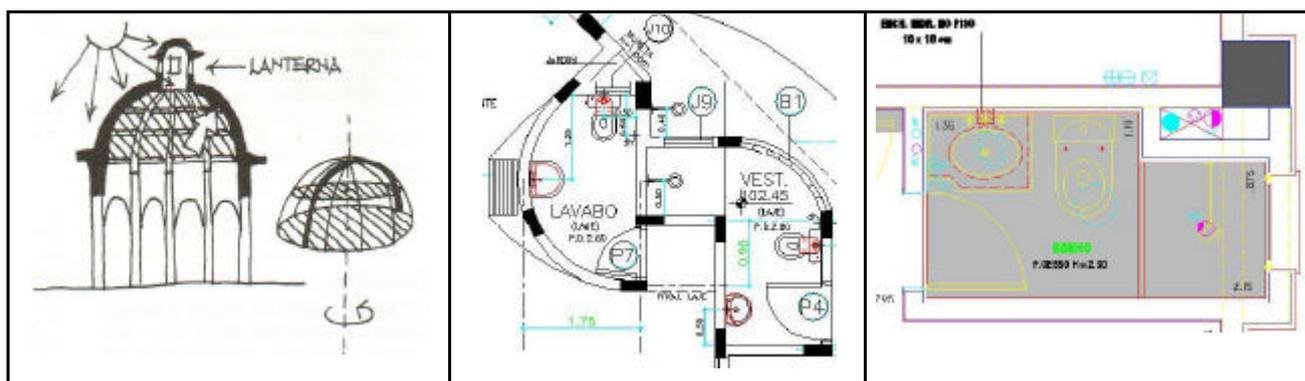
Hachuras pintadas utilizadas em desenhos a mão/eletrônico.
